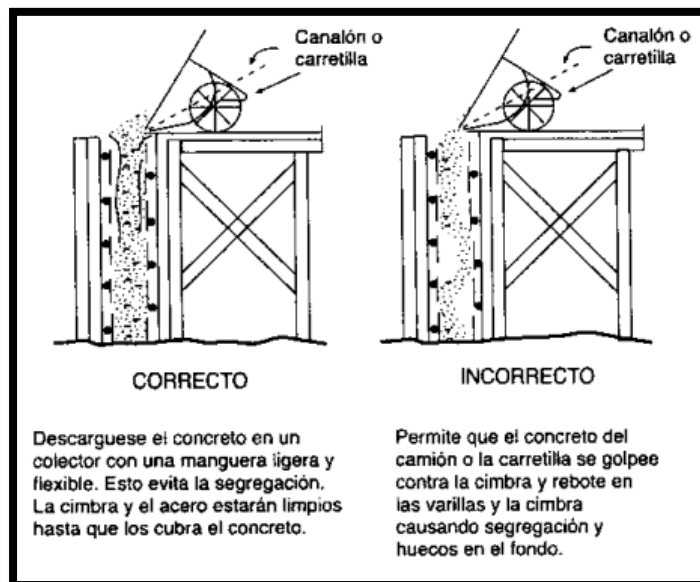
Colado correcto he incorrecto en elementos verticales (Fuente: Instituto Mexicano del Cemento y el Concreto (IMCYC), México (1999). Manual para supervisar obras de concreto, ACI 311-99, Fig. 9.4(a))
